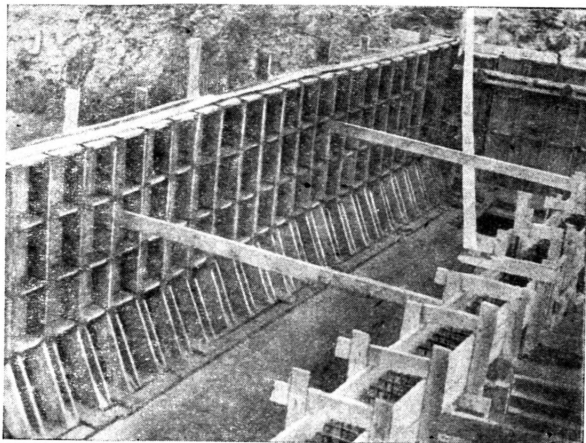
Общий вид деревянной опалубки резервуара, бетонированного отдельным методом
